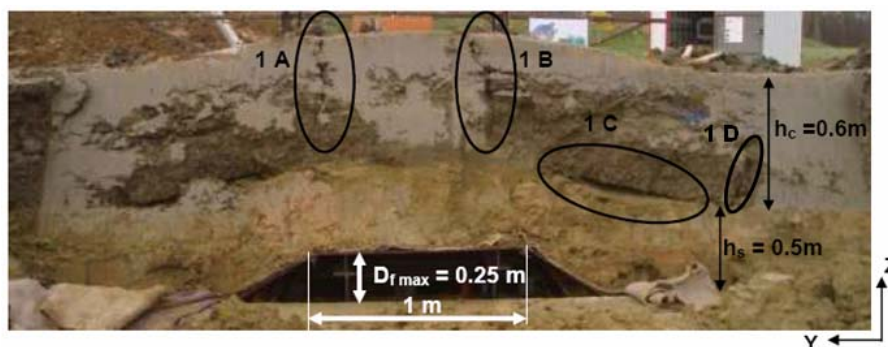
Coupe verticale de la planche T1 à la fin de l'essai
